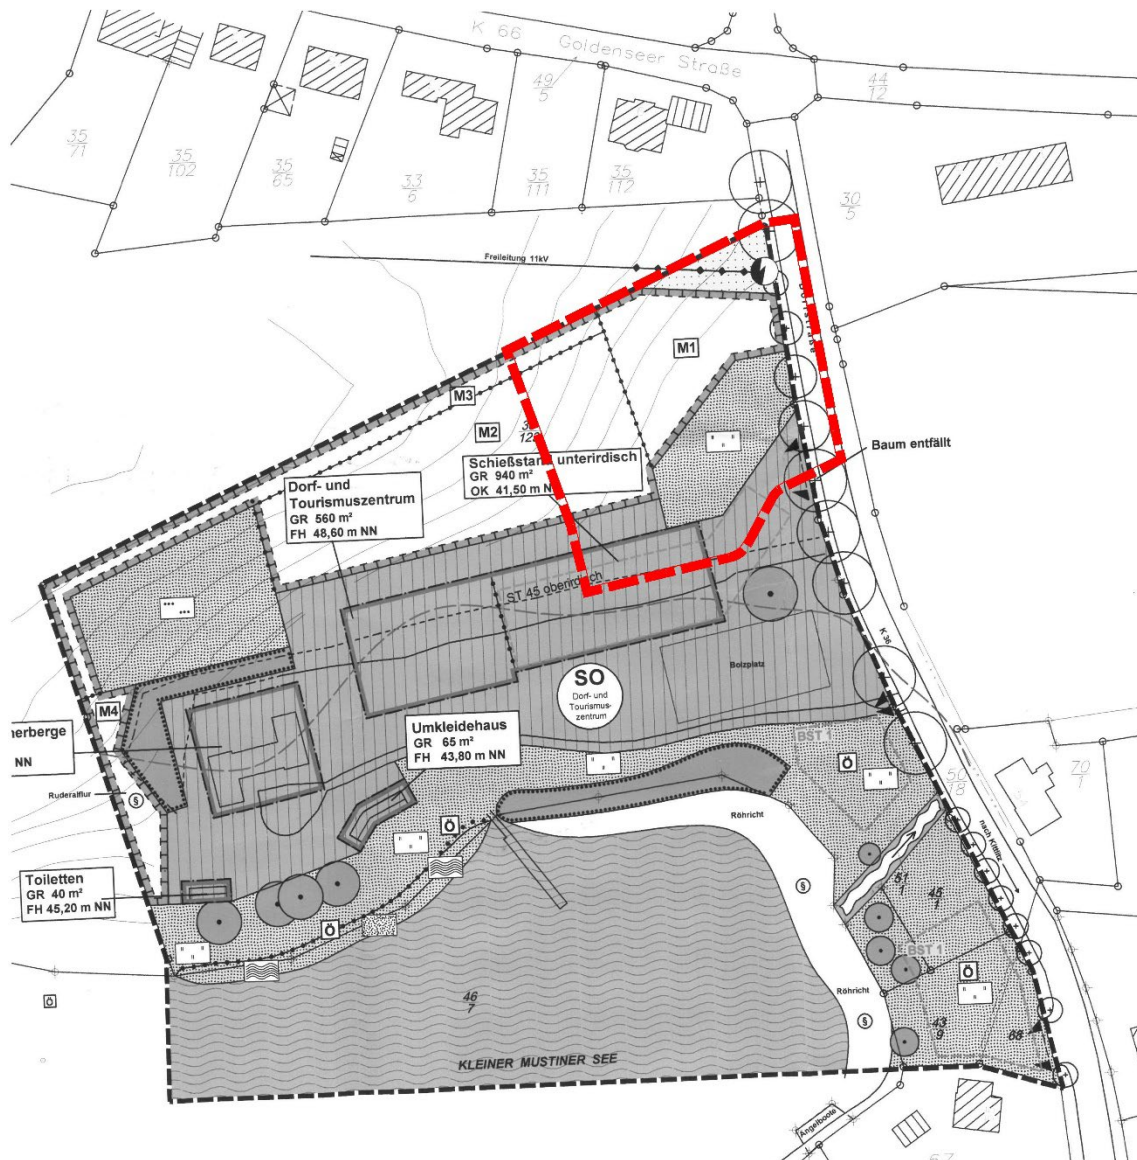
Überlagerung des bestehenden (Bebauungsplan Nr. 4) und künftigen Planungsrechtes des Bebauungsplanes Nr. 8
